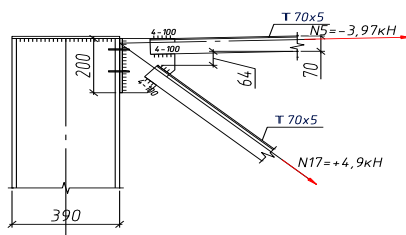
Узел примыкания верхнего пояса с надколонником
